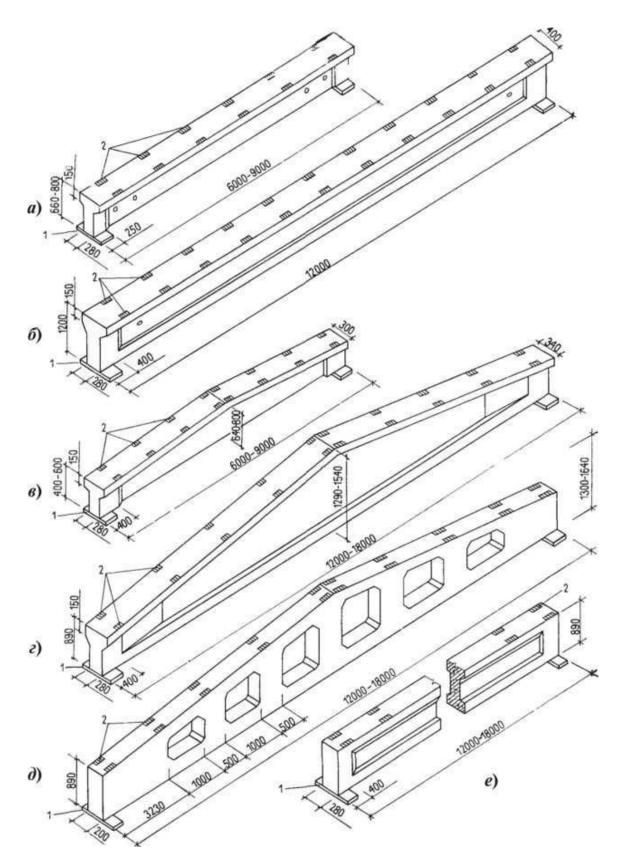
Железобетонные балки: а) односкатные таврового сечения; б) односкатные двутаврового сечения; в) двускатные (для пролетов 6...9 м); г) двускатные (для пролетов 12...18 м); д) решетчатые (для пролетов 12...18 м); е) с параллельными поясами; 1 — опорный стальной лист; 2 — закладные детали.
